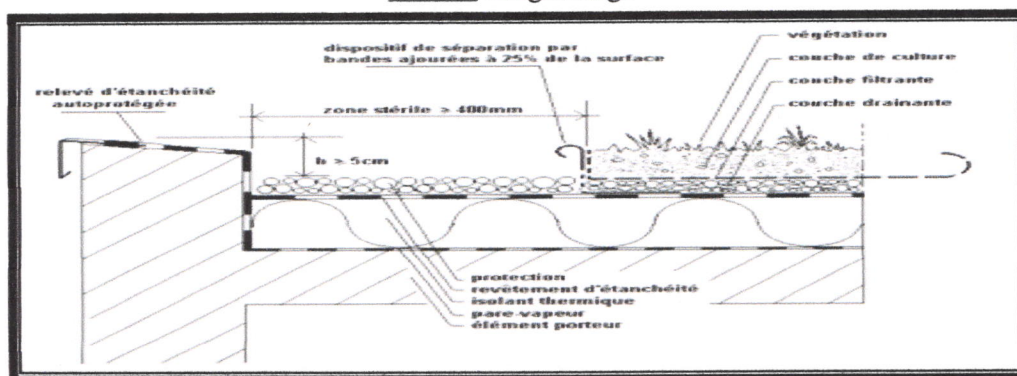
COUPE SUR UNE TOITURE VEGETALISME
